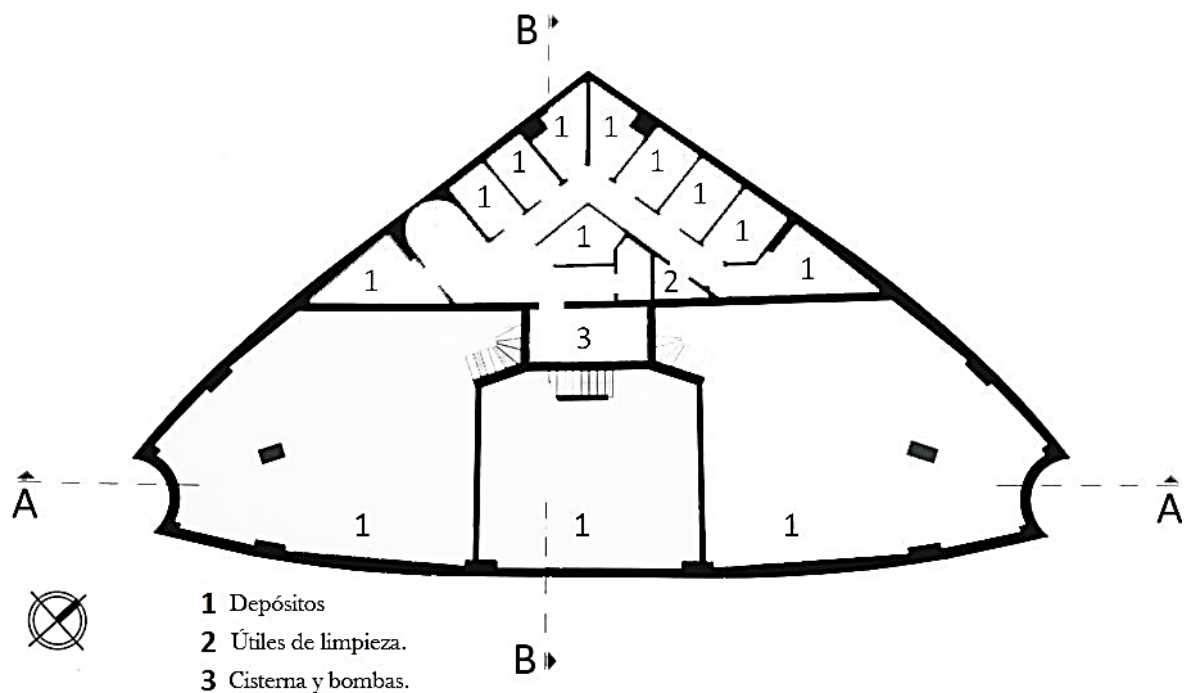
Planta del sótano. Planta elaborada por Viccina (2015).
